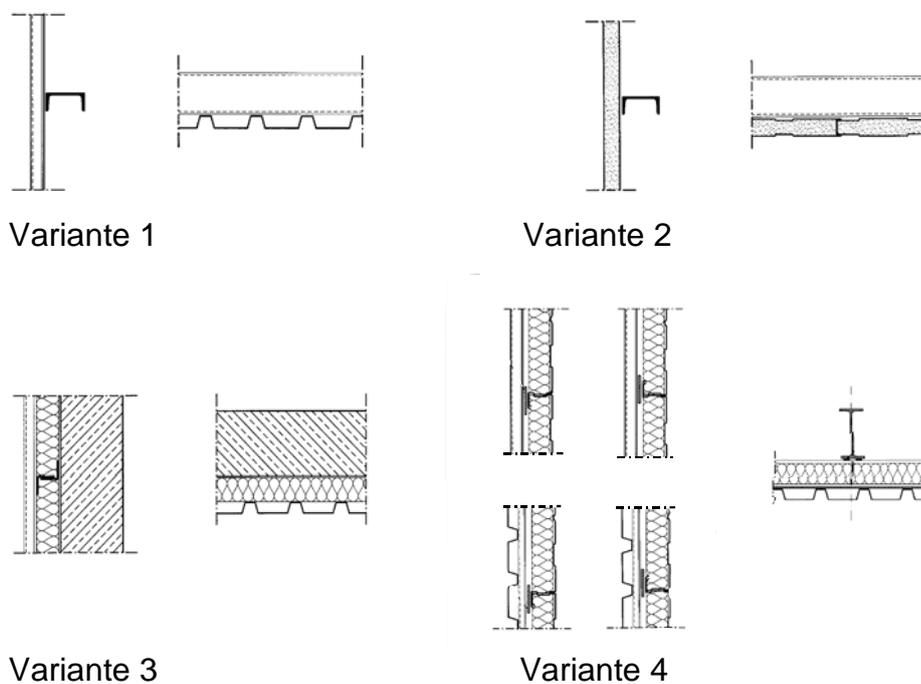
Charakteristische Fassadendetails im Metallbau
